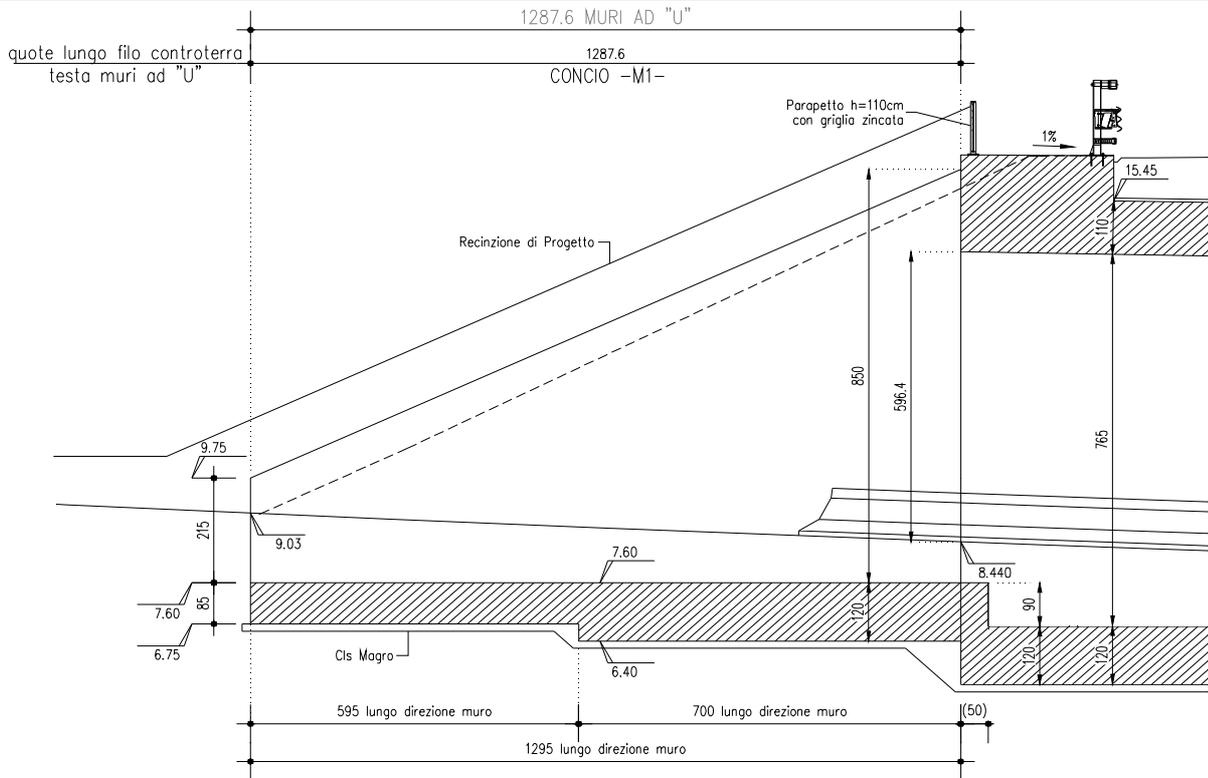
SEZIONE LONGITUDINALE MURO D'ALA AD U
